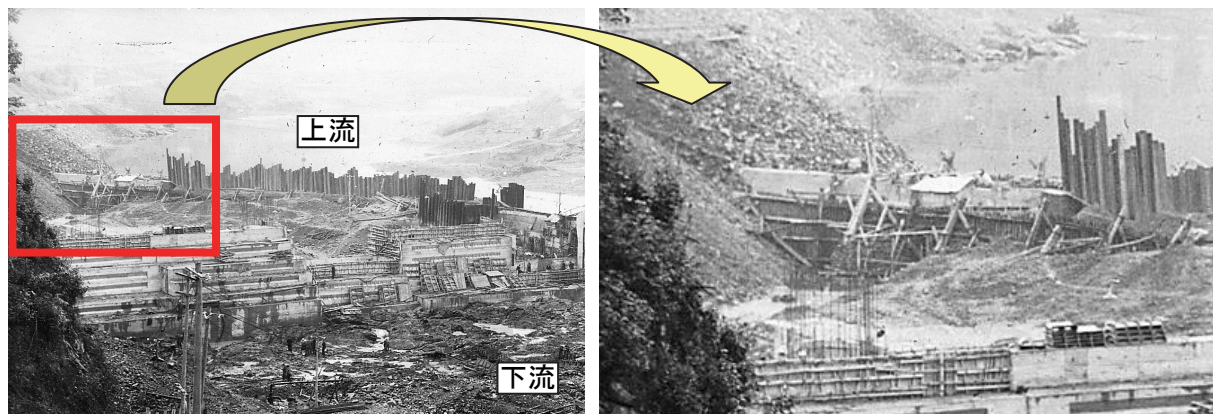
上流側締切コンクリート部の状況 (コンクリート打設)
